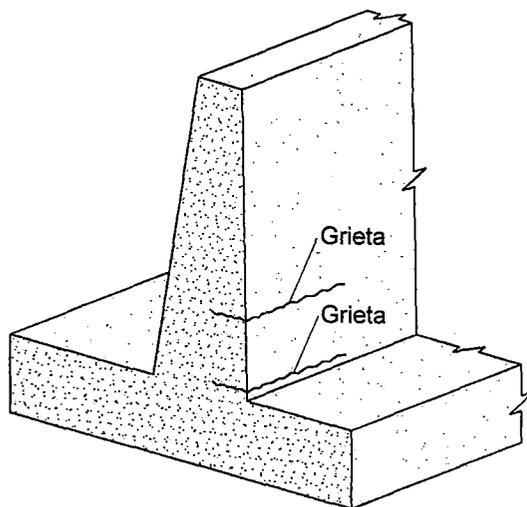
Agrietamiento de un muro por contracción térmica inicial.
